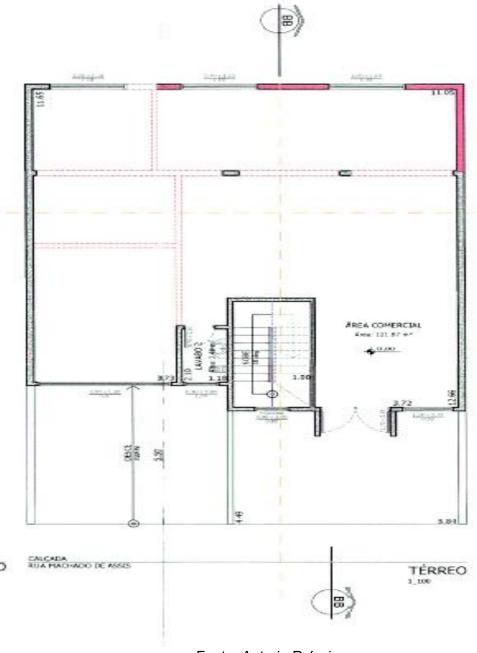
Planta Baixa Térreo Estudo de Caso 3
